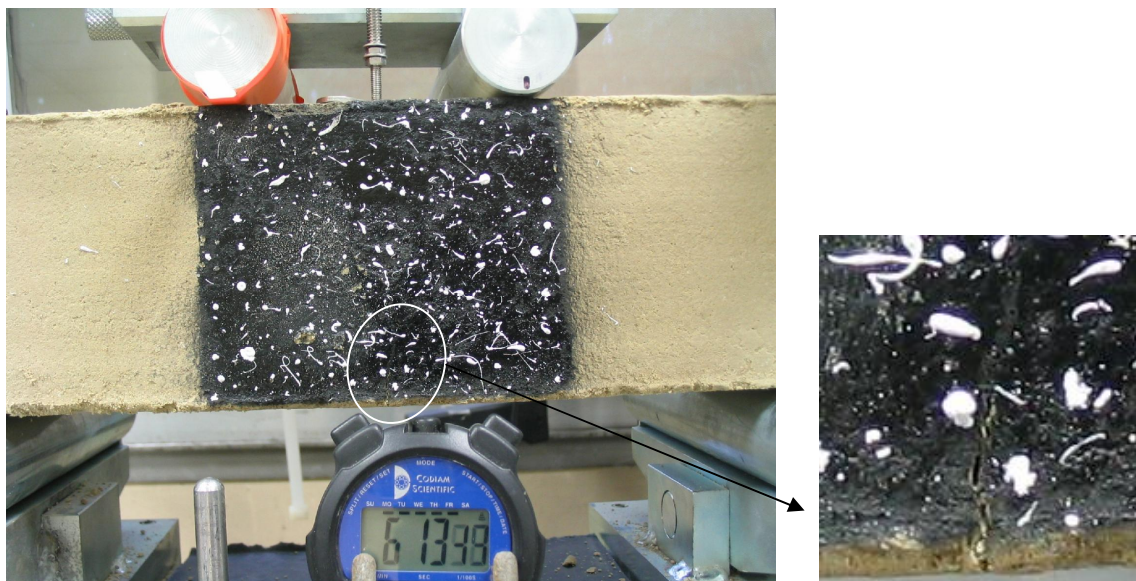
Initiation de la fissuration (déplacement des rouleaux de chargement = 1,24 mm)
